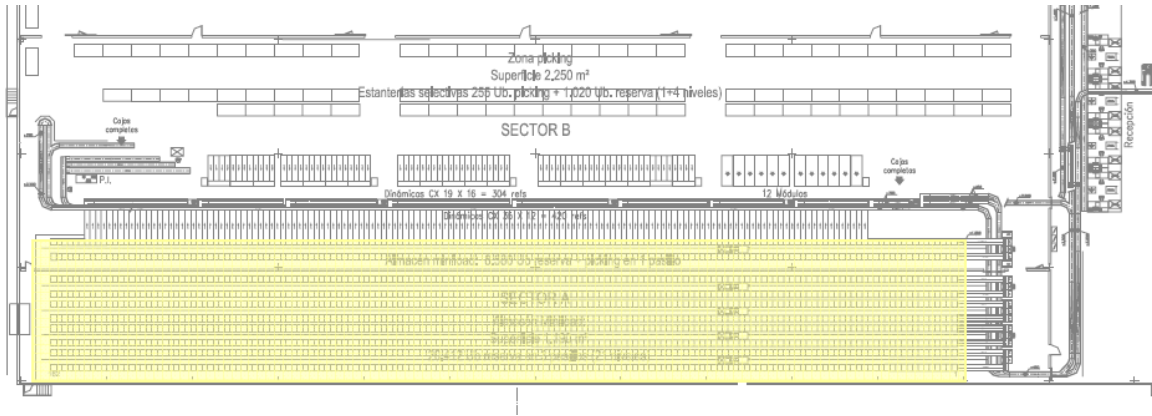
Detall ubicació en planta de les prestatgeries de miniload
